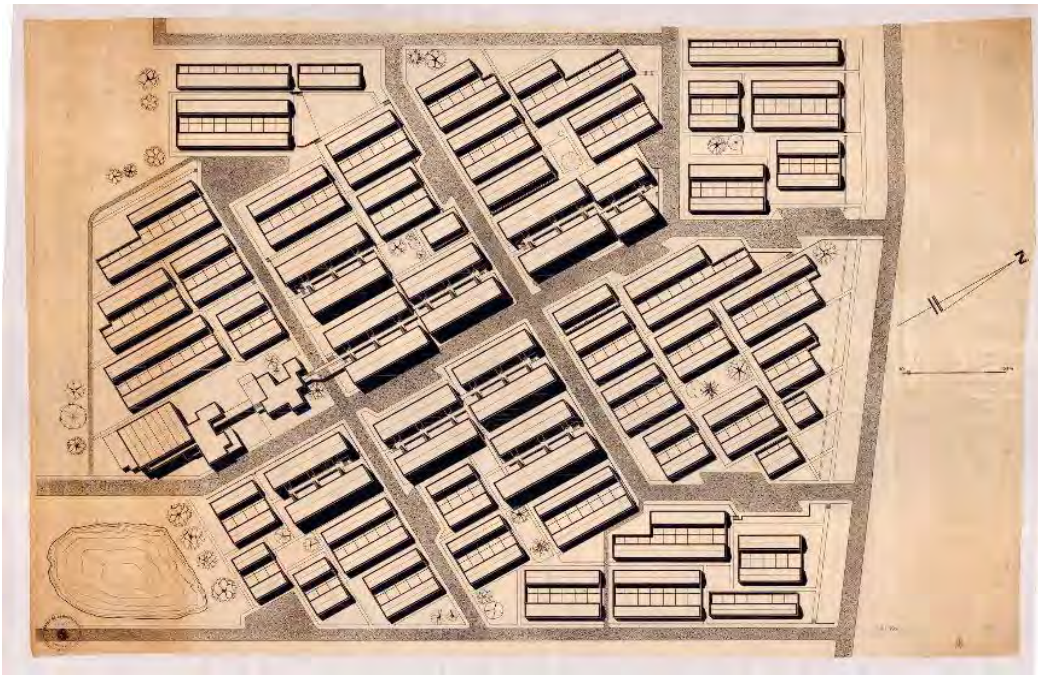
Cooperativa José Pedro Varela, zona 3. Planta general del conjunto. Fuente: Pl.37450. Archivo IH. FADU.
